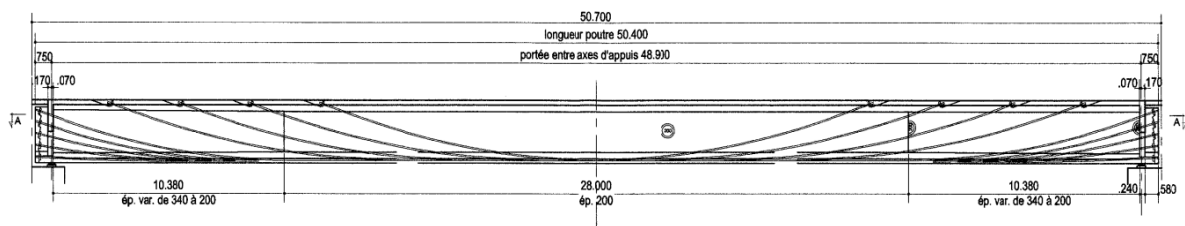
COUPE LONGITUDINALE ET TRACE DES CABLES DE PRECONTRAINT POUR LA POUTRE C
